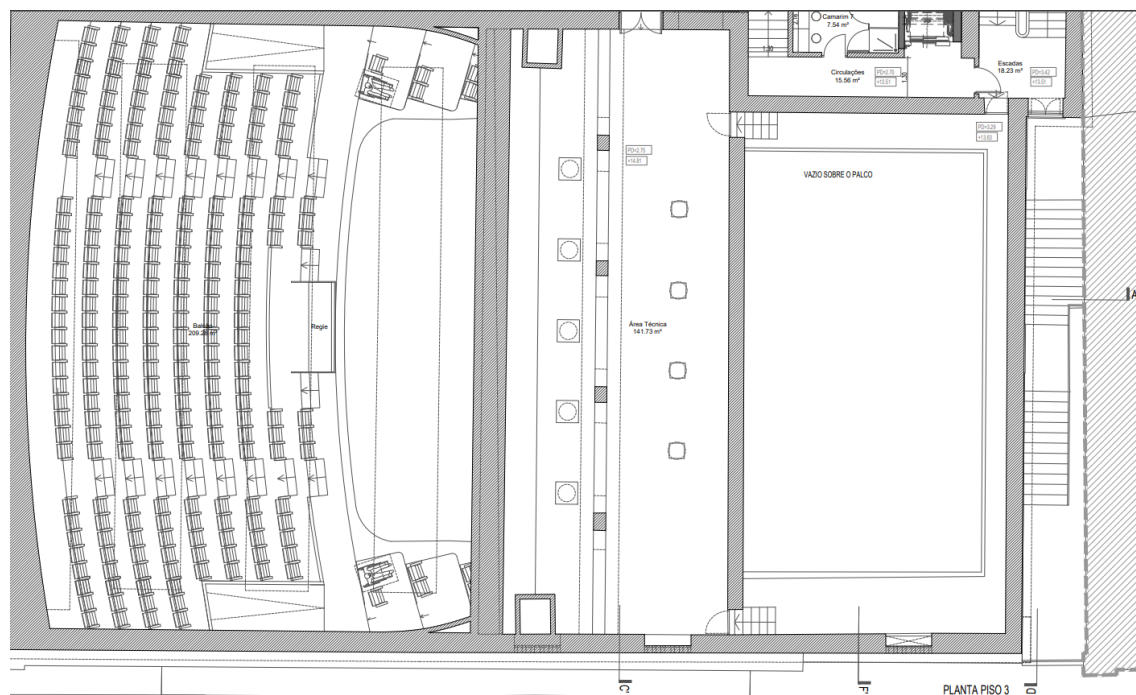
Planta do Piso 2 da sala principal. [33]
